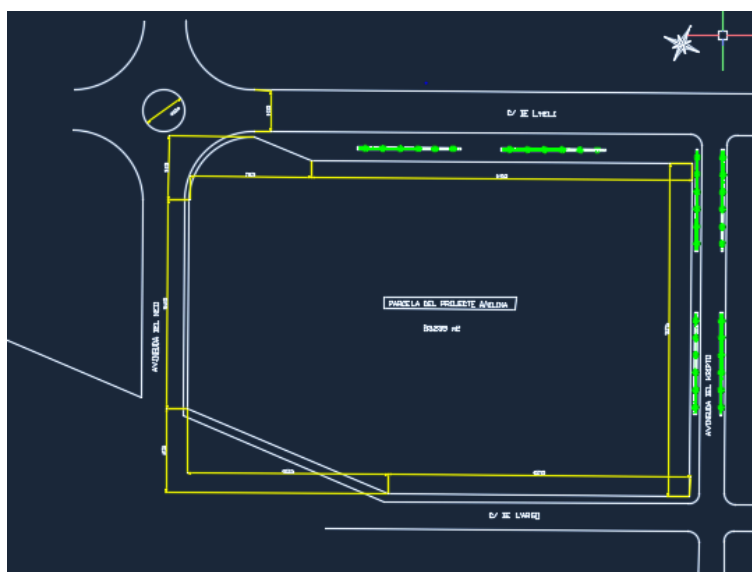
3: Plano de la parcela para la ubicación de la planta de MCB
